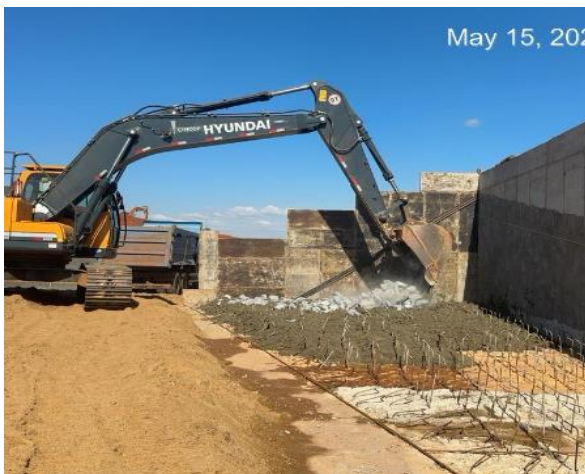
Aplicação de pedra argamassada na execução da ala de transição
